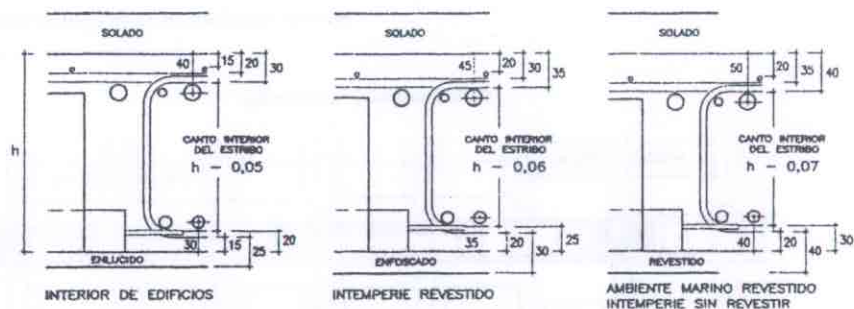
Recubrimientos tipo (en mm) y canto del estribo
